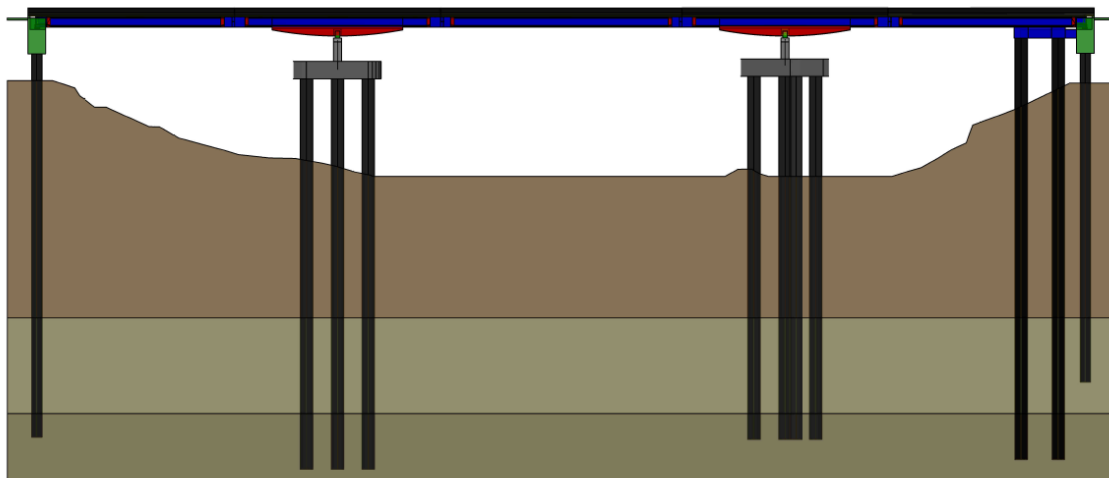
Vista lateral del puente con la estructura auxiliar en margen derecha bajo el puente La Pigua III.
